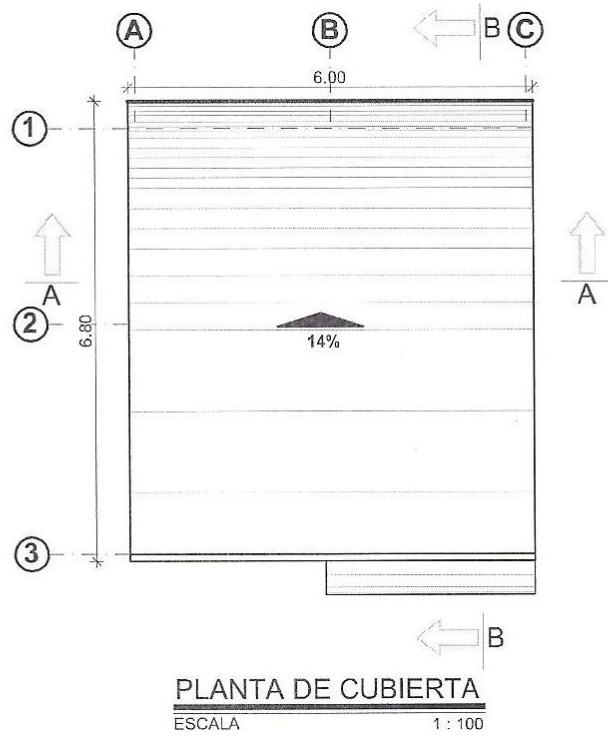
Planta de cubierta. Arquitectura de las viviendas emergentes
